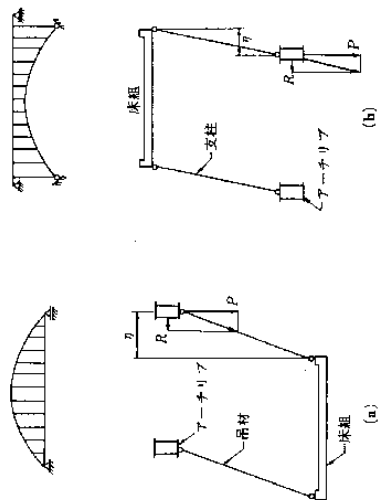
面外座屈時の吊材・支柱の作用
